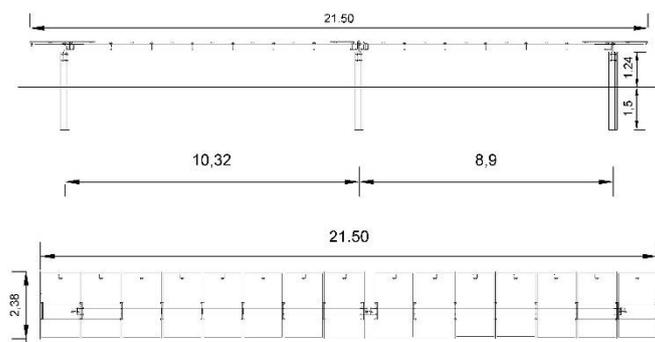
Prospetto frontale e vista in pianta delle strutture (15 moduli) ad inclinazione 0°
